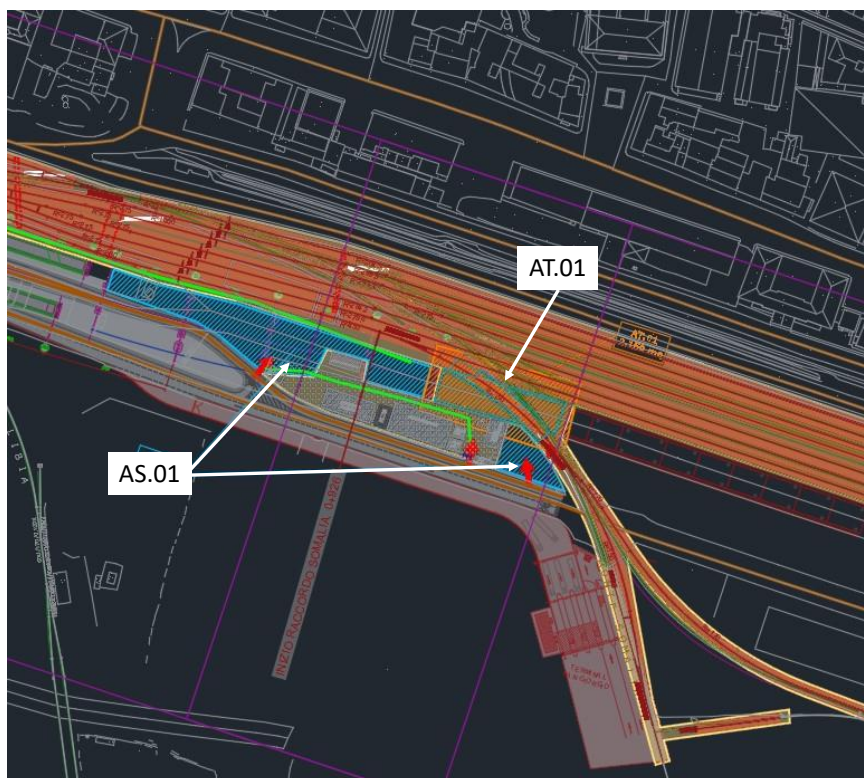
Localizzazione delle aree di cantiere e attività di lavorazione
